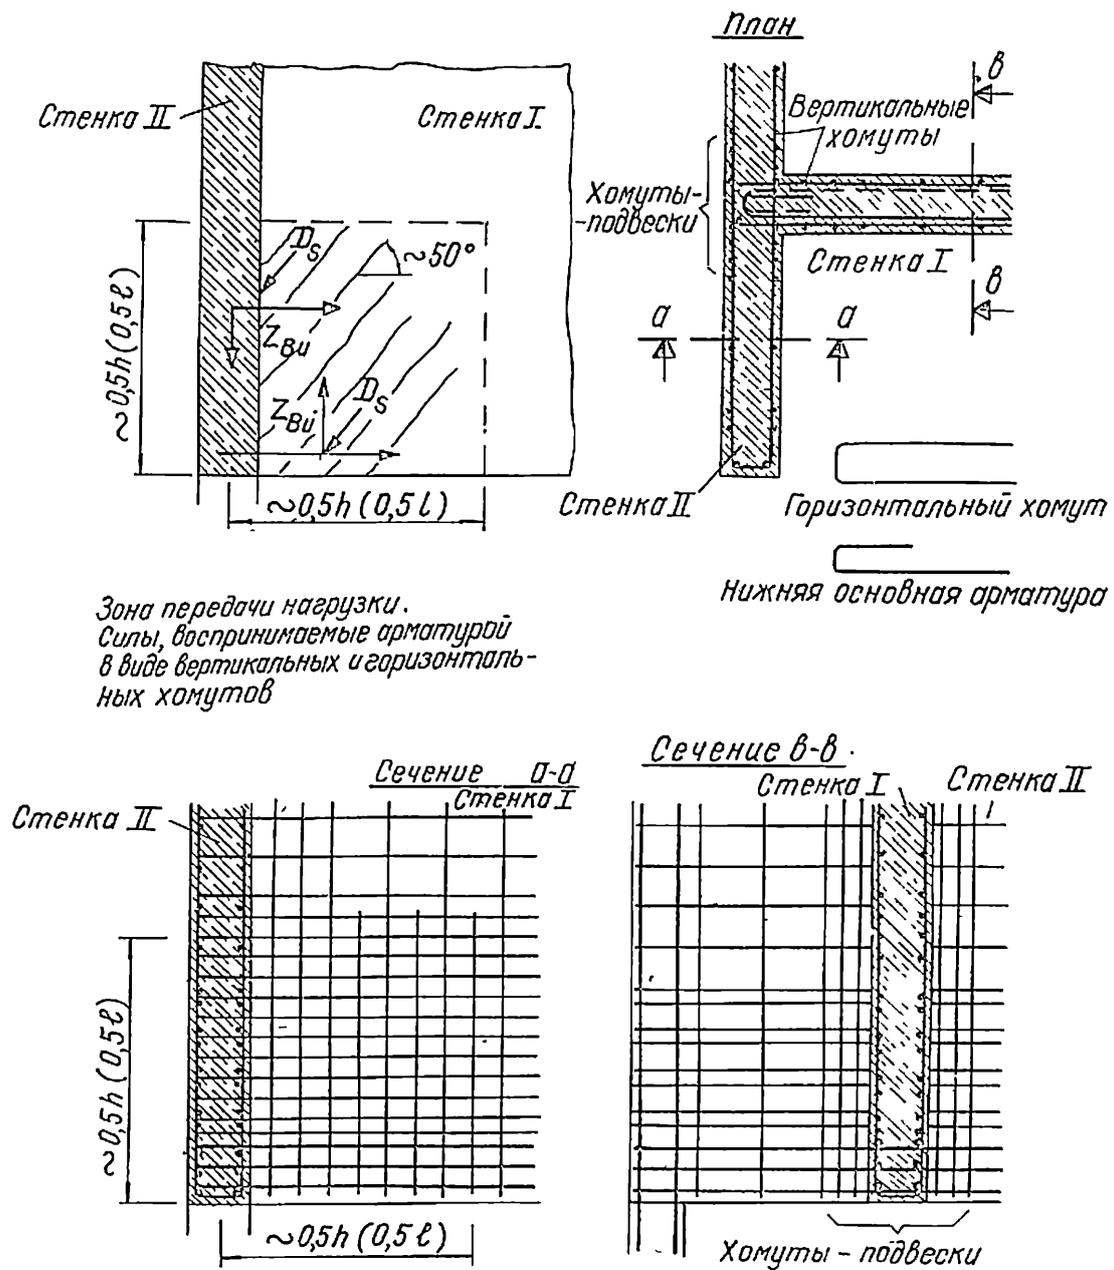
14. Армирование зоны сопряжения стенок при умеренных усилиях, возникающих в стыке
